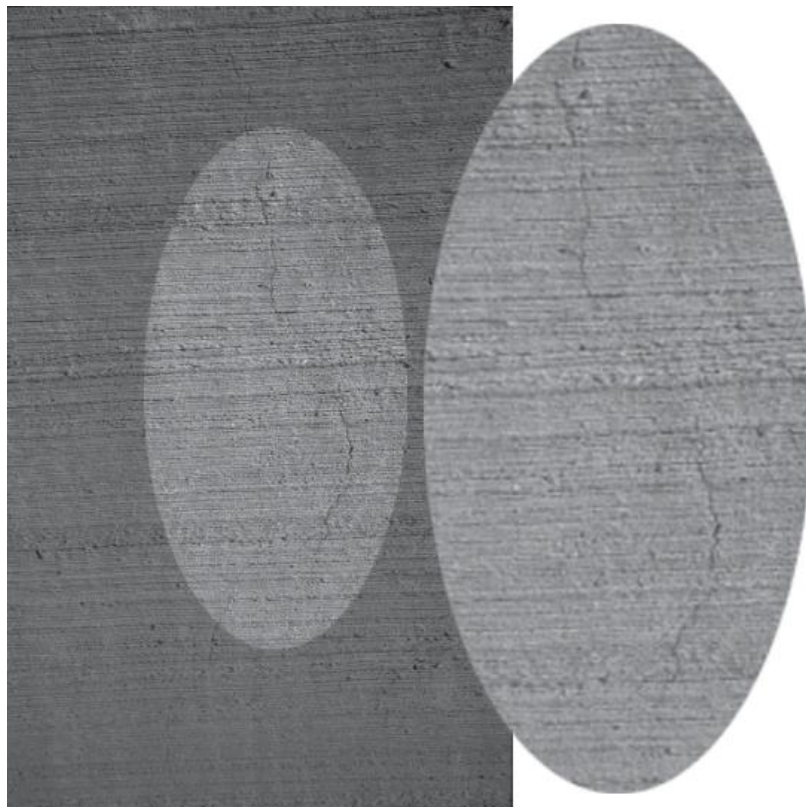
Exemplo de Fissura por Retração Plástica. (Fitesa – Boletim Técnico nº 2, 2002).
